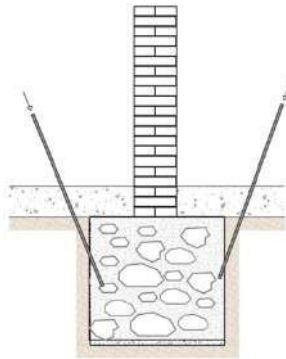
Propuesta de intervención en zapatas aisladas bajo pilar. Fuente propia
